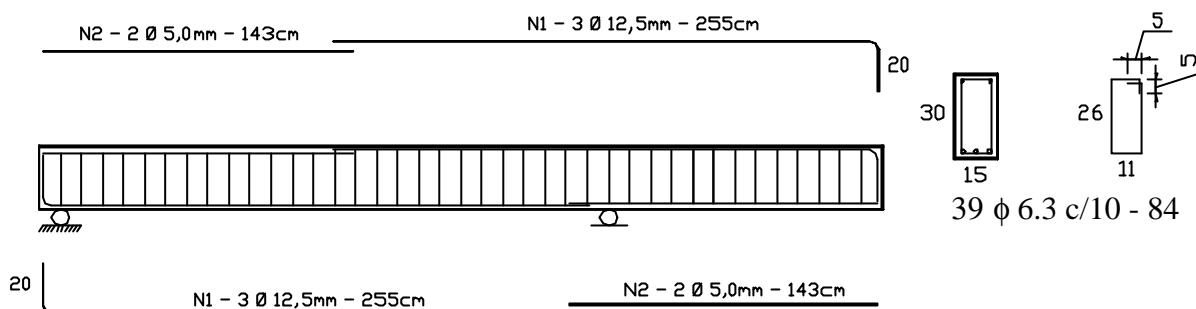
14 – Detalhamento da armadura interna das vigas VR e V1 a V6
